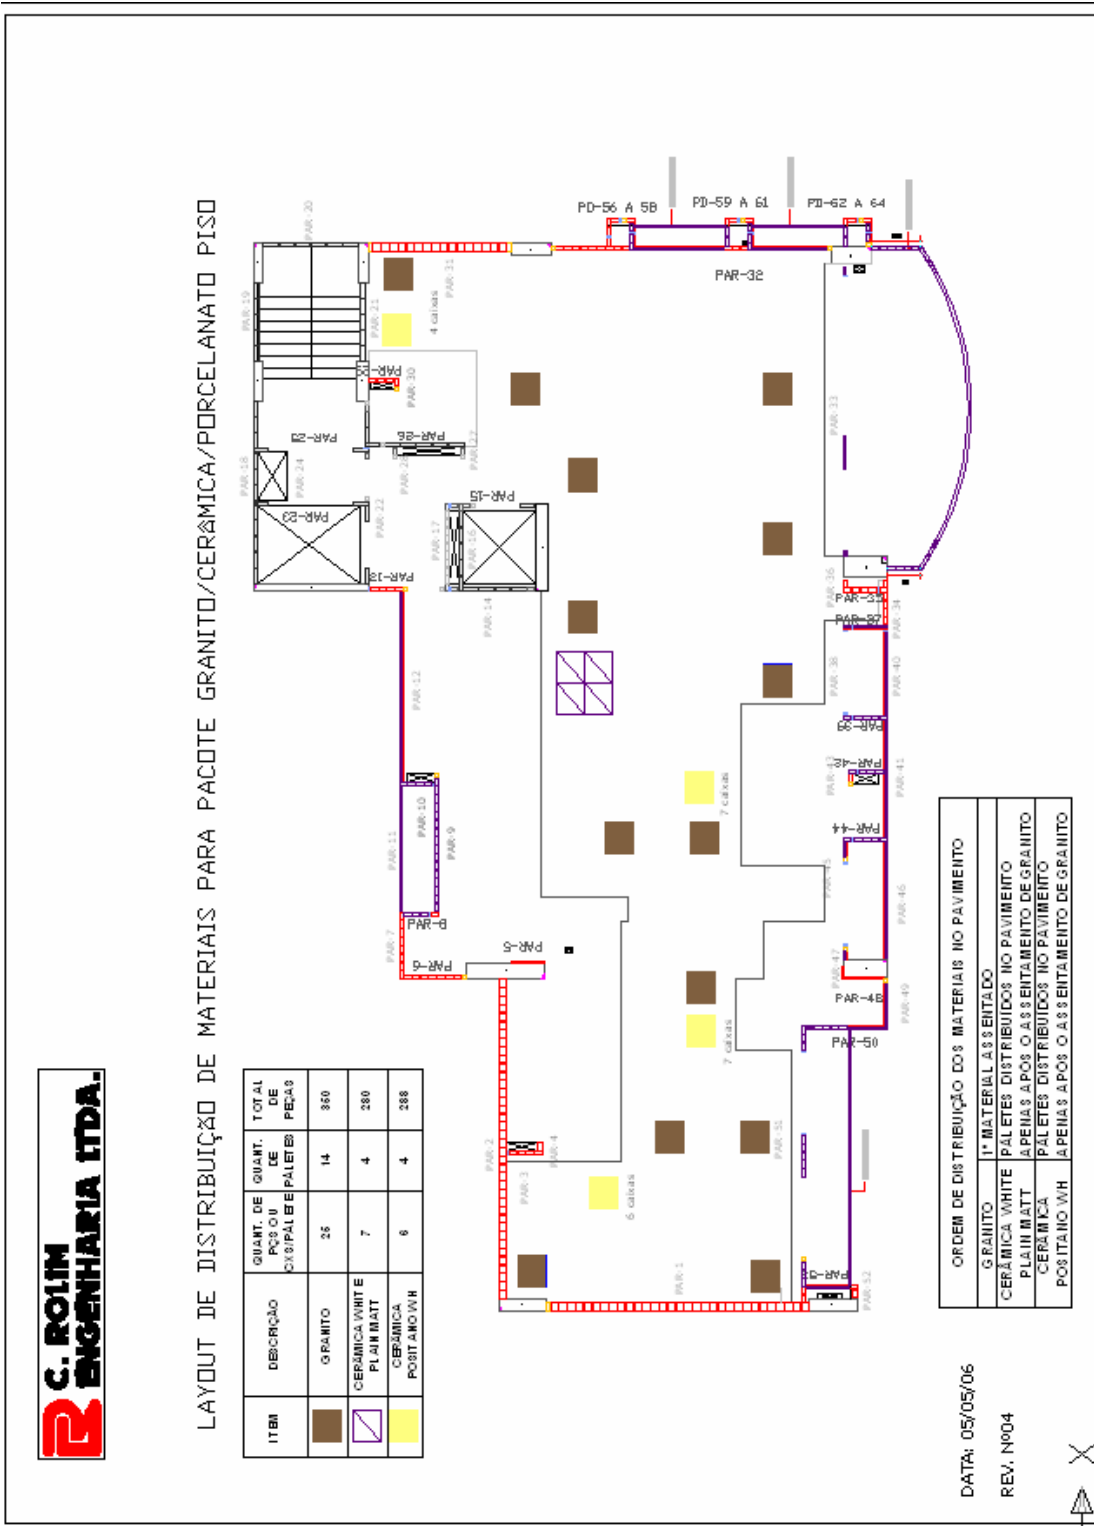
Projeto de Distribuição dos Materiais no Pavimento
